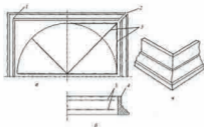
Изготовление абак дорической капители: а — план; б — разрез; в — склеенный угол: 1 — склеенный угол; 2 — приготовленный к склейке угол; 3 — арматура; 4 — профиль абак.
